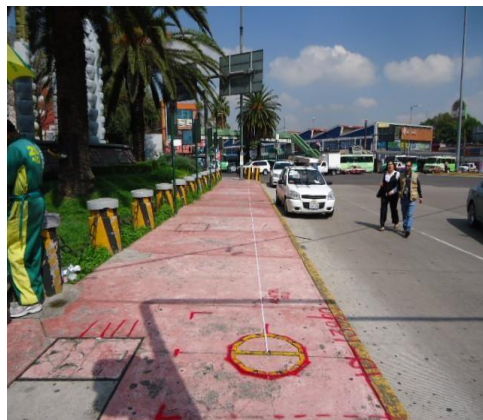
Levantamiento para la instalación de poste de 20m Autoría propia.
